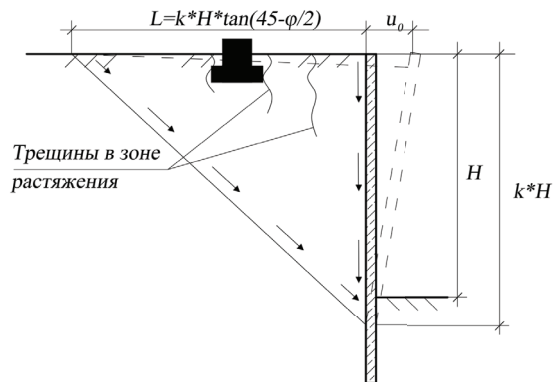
Схема к определению осадок и горизонтальных перемещений фундаментов вблизи котлованов
